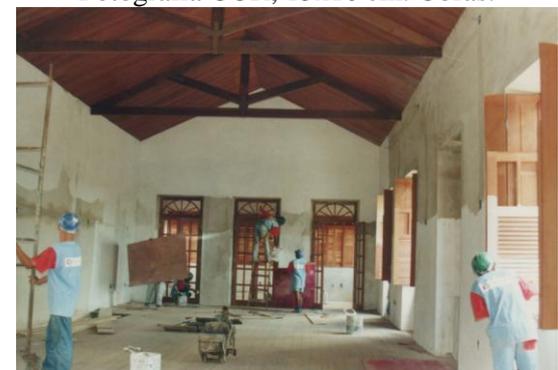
Fachada. Fotografia COR; 10x15 cm. Obras.
